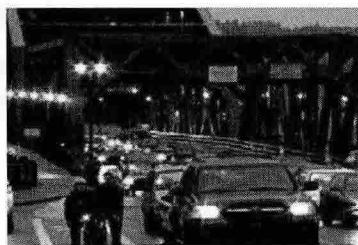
Broadway Bridge 시공 완료 후 차량통행(미국, 2004)
